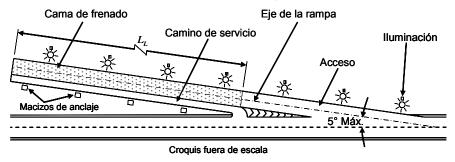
Rampa de emergencia para frenado. Disposición en planta
